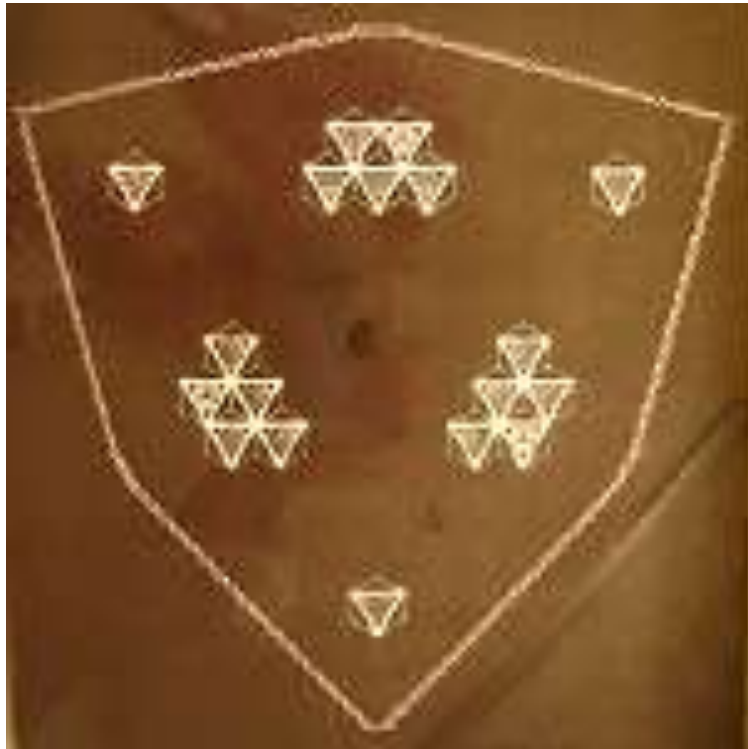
Sección en planta de la versión más temprana de la City Hall Tower.
